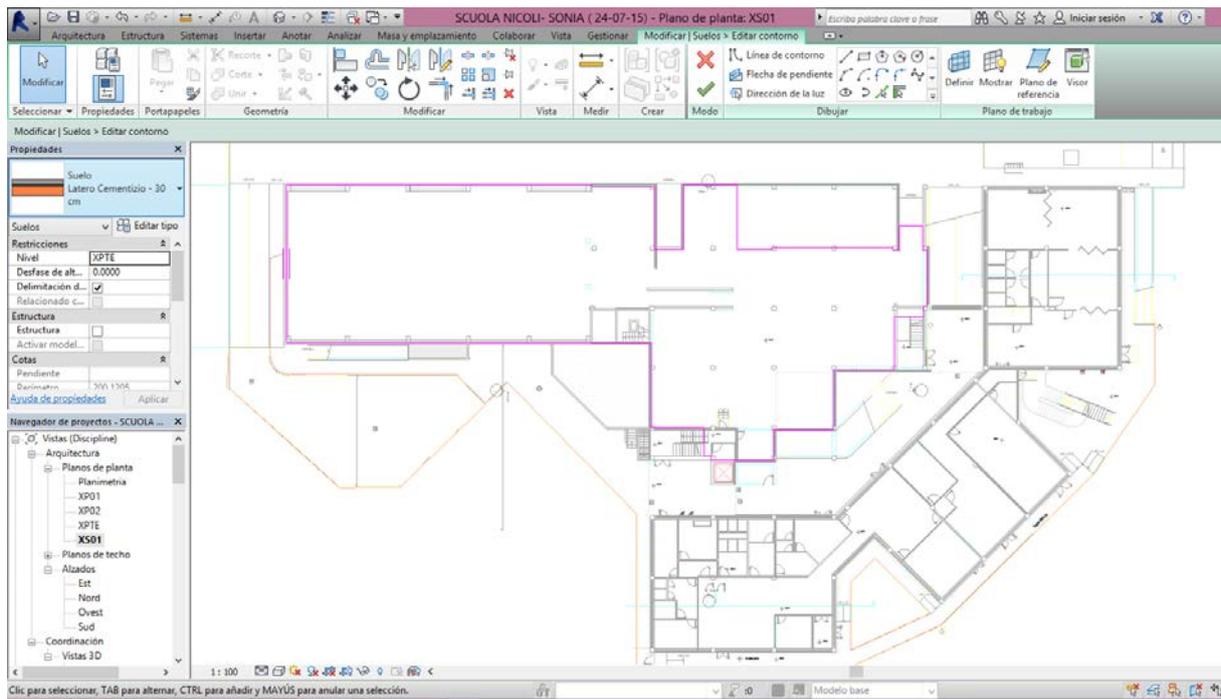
Realizzazione perimetro pavimentazione (Fuente propio)
